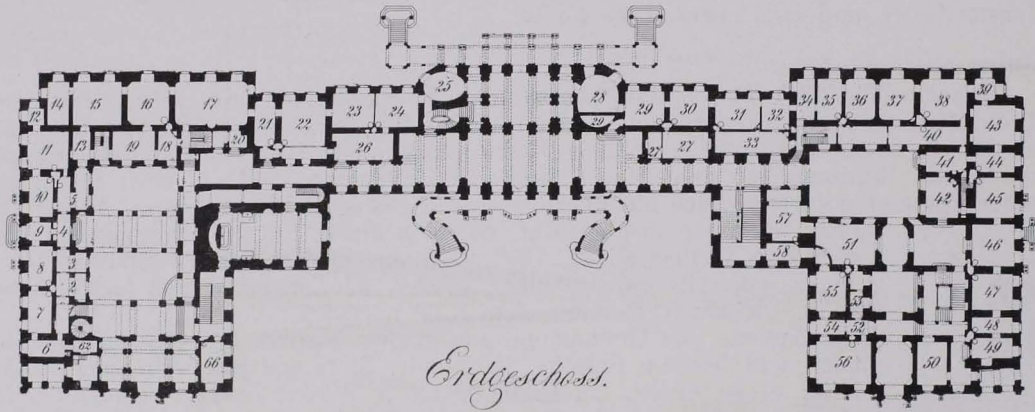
Schönbrunn, Grundriß des Erdgeschosses (S. 118)
